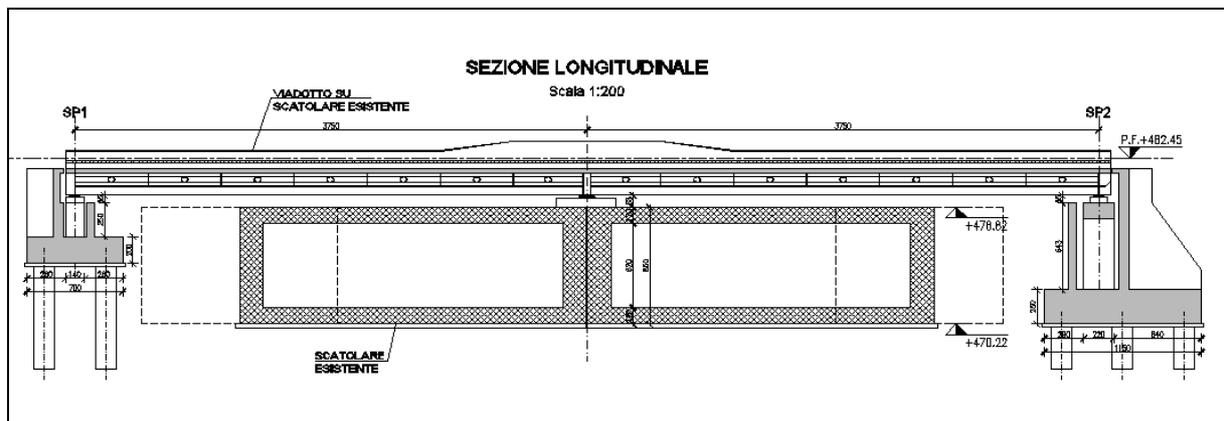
Sezione longitudinale ponte LS su autostrada A32
